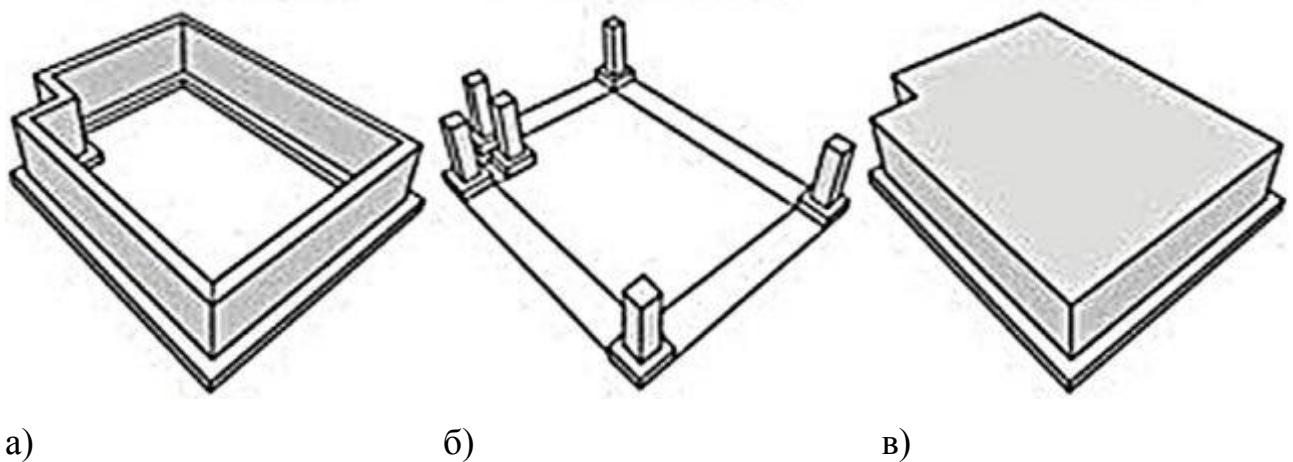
Типы фундаментов: а – ленточный, б – свайный, в – плитный
